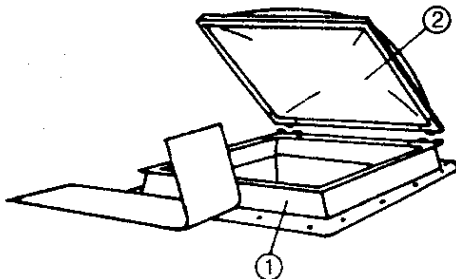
Aufsetzkranz ① entsprechend der Flachdachrichtlinie des Zentralverbandes des Deutschen Dachdeckerhandwerks - Ausgabe Mai 1991 - auf dem Untergrund, z.B. Holzbohlenrahmen, verschrauben und in die Dachhaut einbinden.
